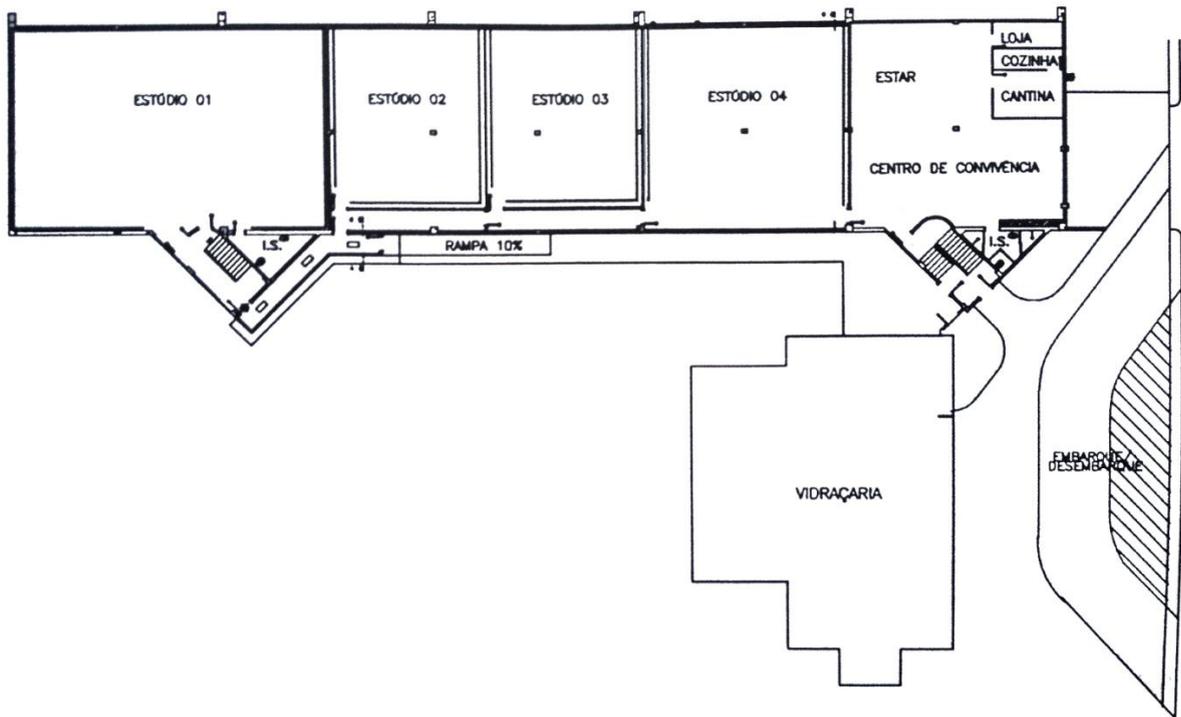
PLANTA DO PAVIMENTO TÉRREO DA ATUAL SEDE DA EDTG
